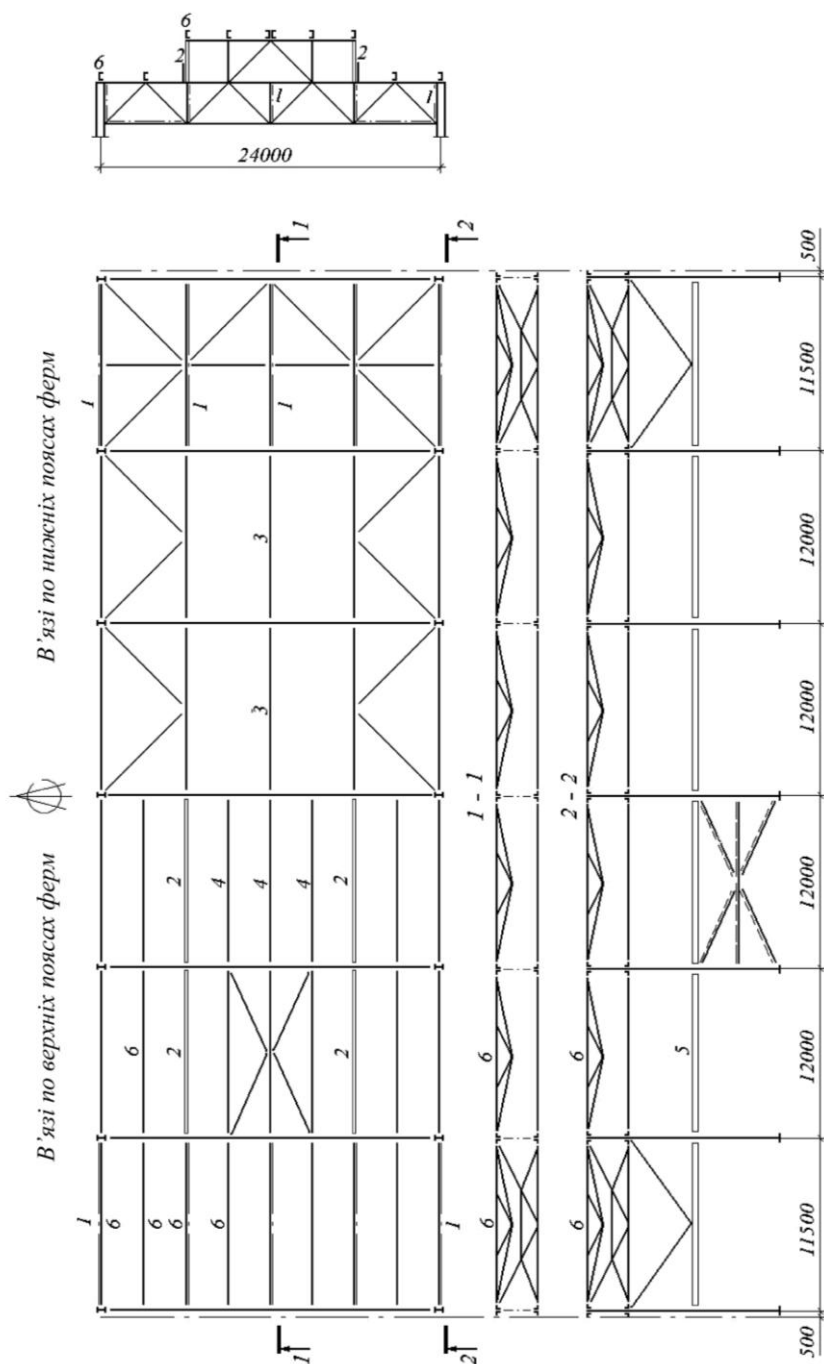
Схема в'язей каркаса при прогонному рішенні та кроці ферм і колон 12 м:
